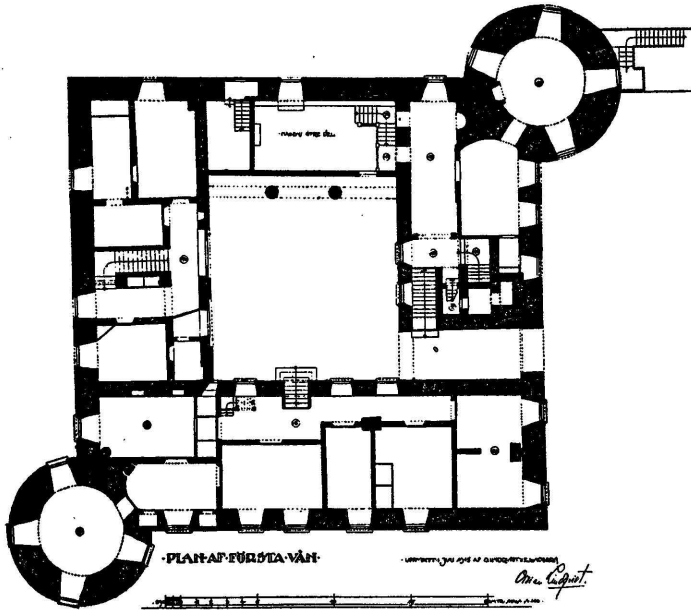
Torup, Grundriss des ersten Stockwerks. Nach H a h r.
